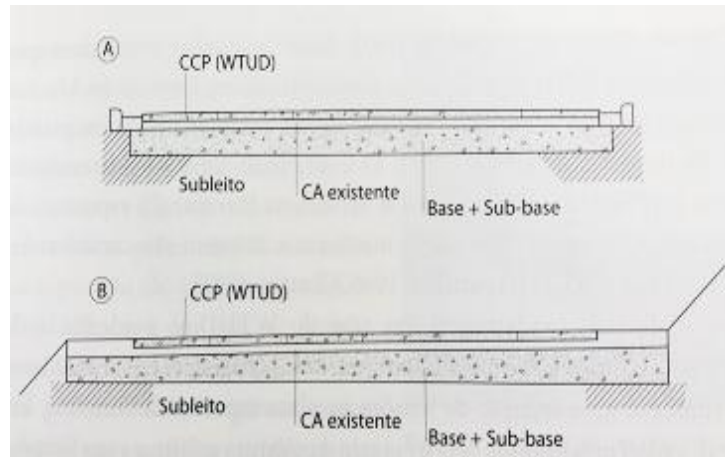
Pavimento de Concreto Whitetopping Ultradelgado. (A) Sistema Sobreposto e (B) Sistema Encaixado
